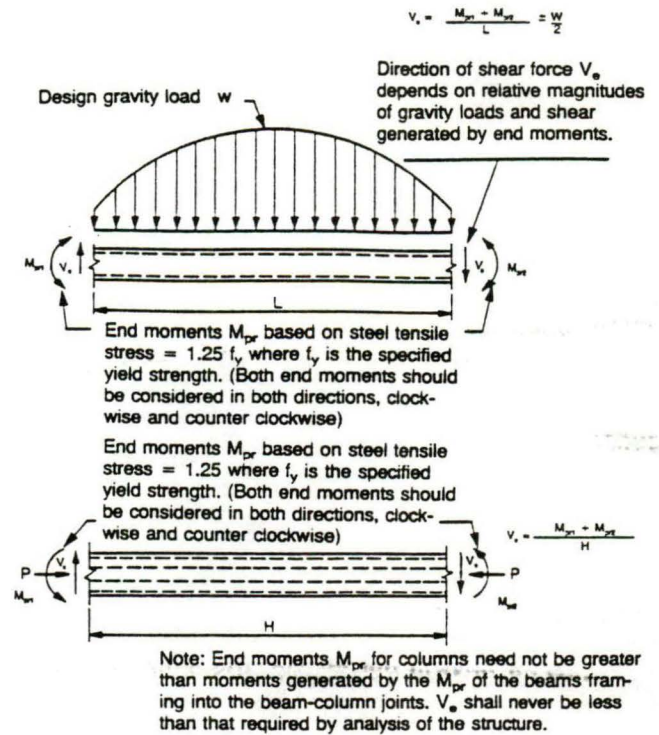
Esfuerzos de corte de diseño de vigas principales y columnas
